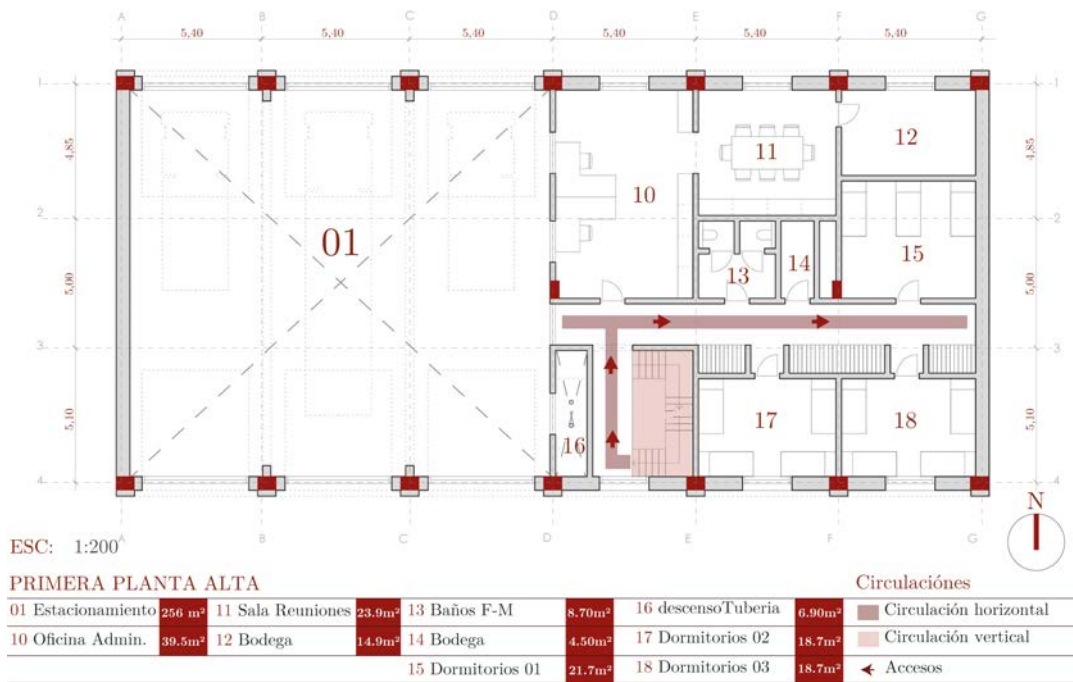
Primera planta alta de la Estación de Bomberos Wilrijk, Amberes. Elaboración: Propia.
